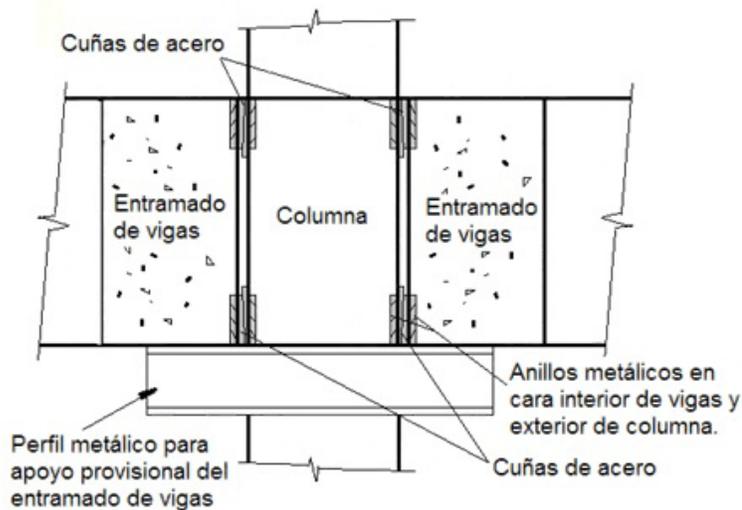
Unión vigas-columna sistema Losa izada. Fricción mediante cuñas de acero. Fuente: Elaboración propia.
